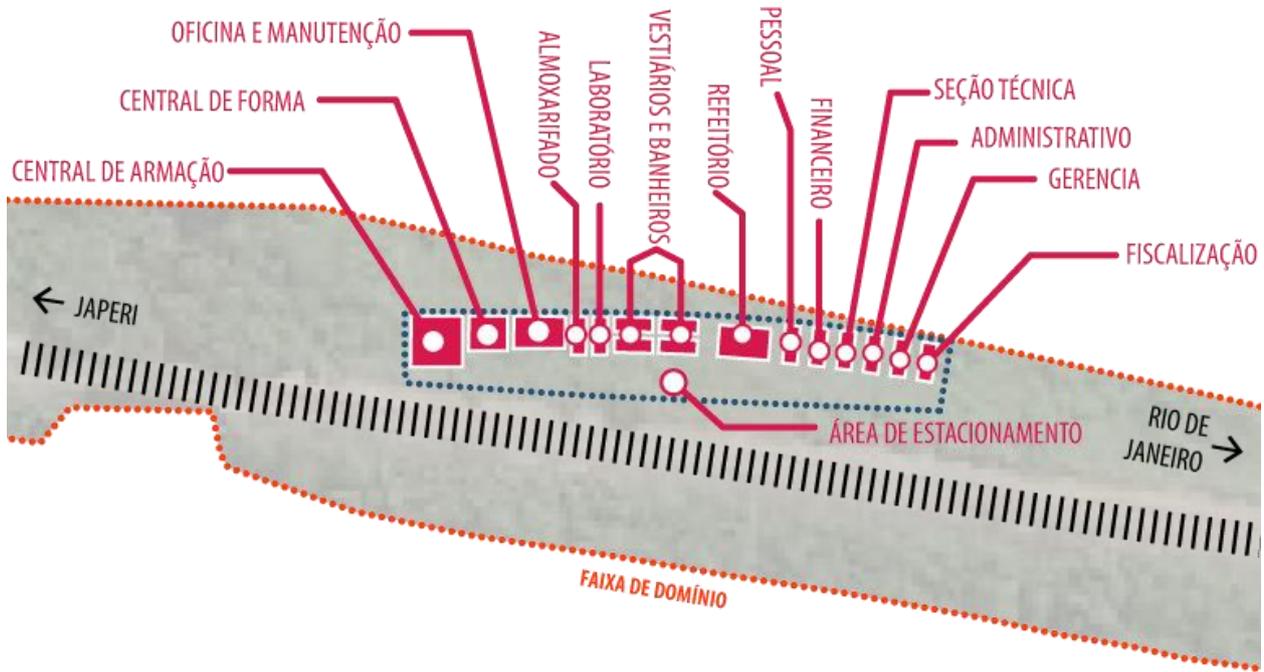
Croqui das estruturas previstas no Canteiro de Obras.
